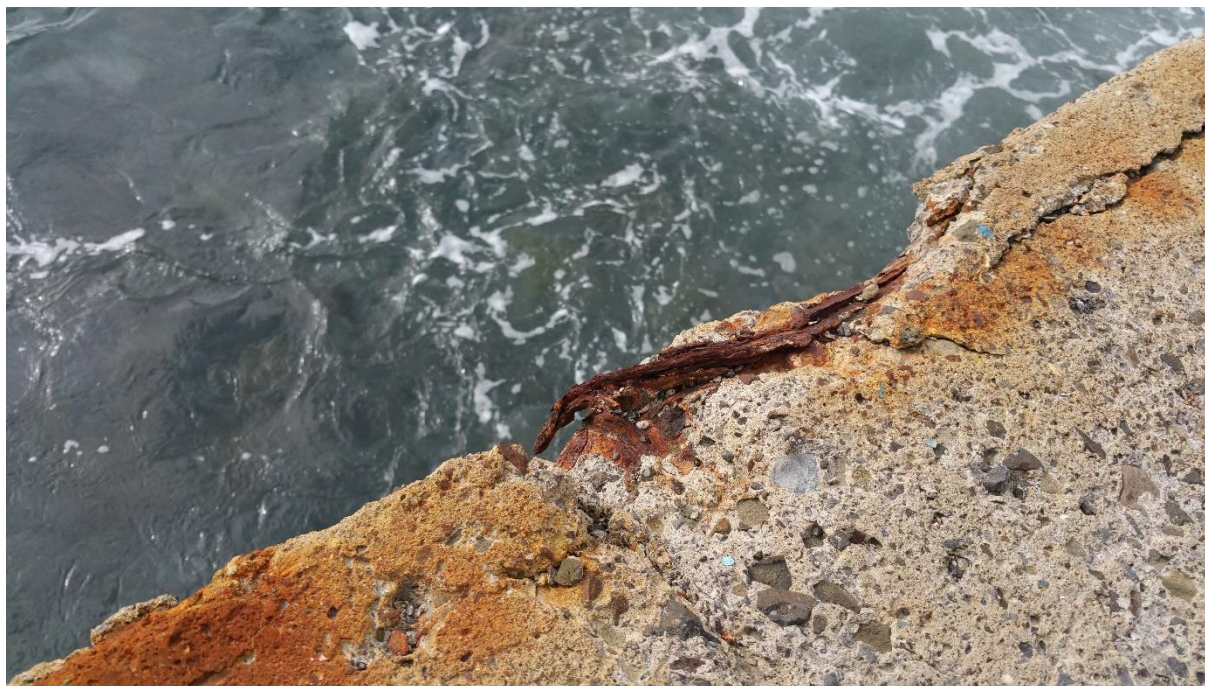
Má colocação das armaduras numa laje junto ao mar
